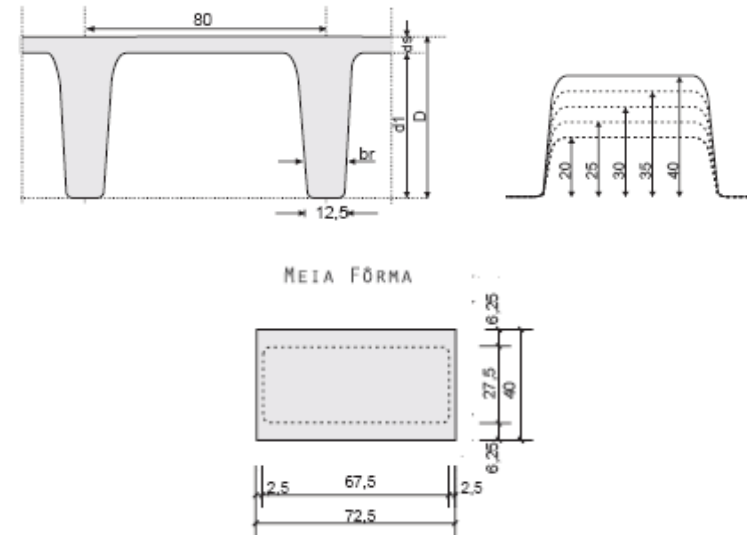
Formas para execução de lajes nervuradas. Especificações de dimensionamento. Ne estrutura foi utilizada meia forma para que a laje ficasse armada em uma direção, a do menor vão. Fonte: ATEX (www.atex.com.br)
